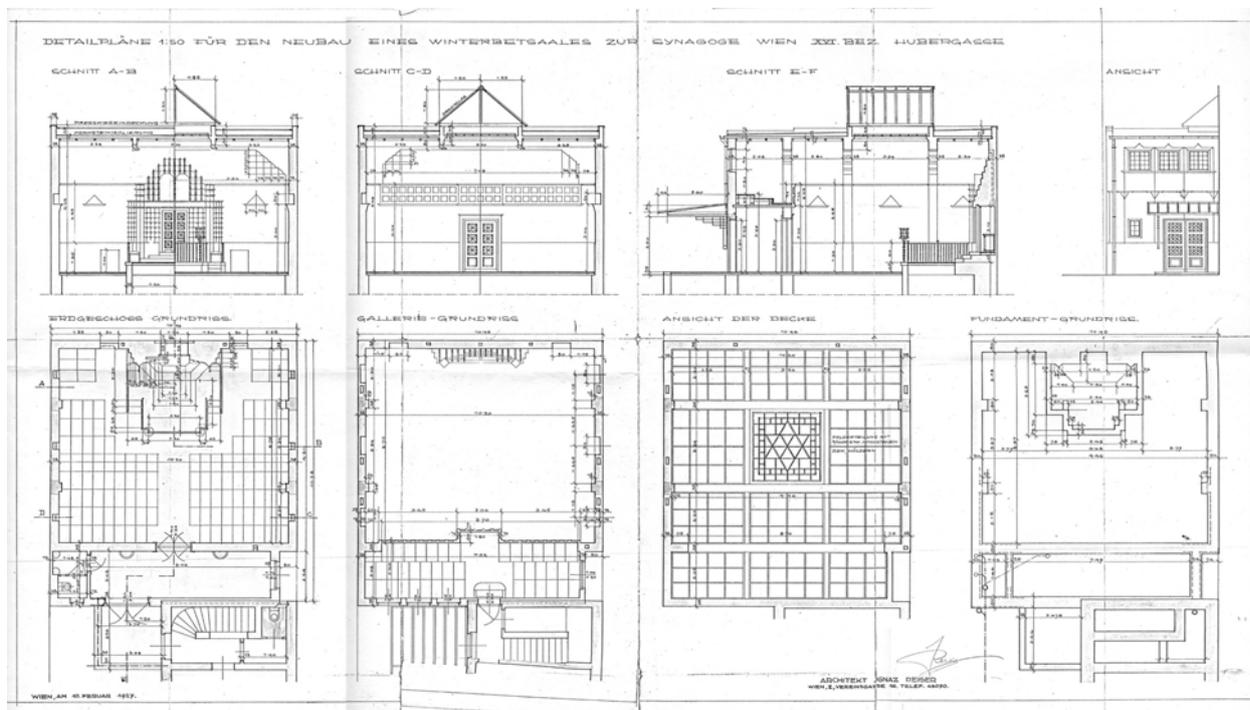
Detailplan für die Erbauung des Winterbetsalles
